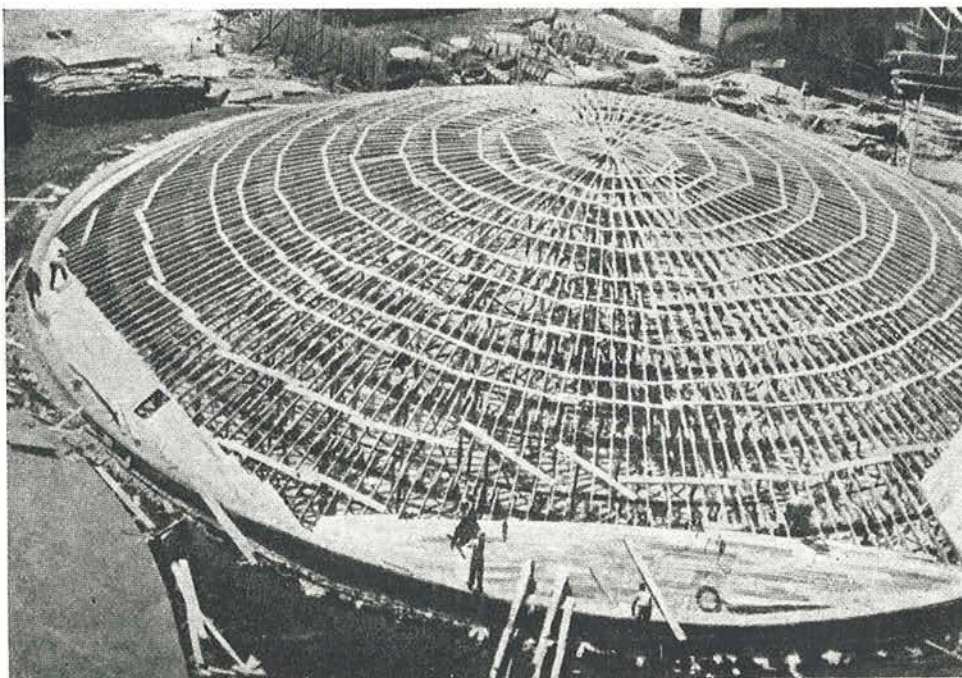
Construcción de la cubierta. Encofrado para moldear la cúpula.
